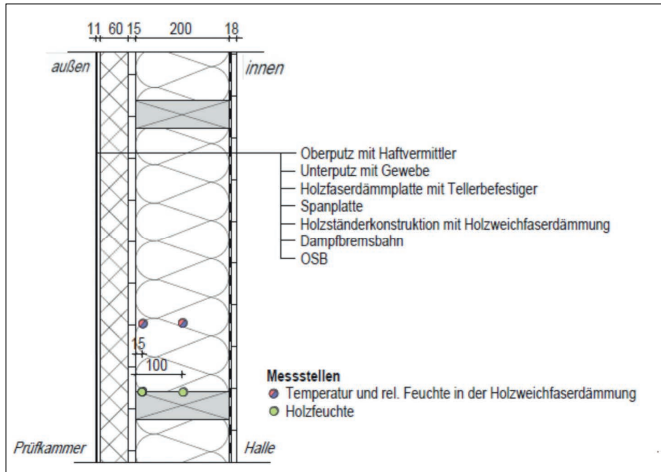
Konstruktionsaufbau mit Lage der Messstellen
